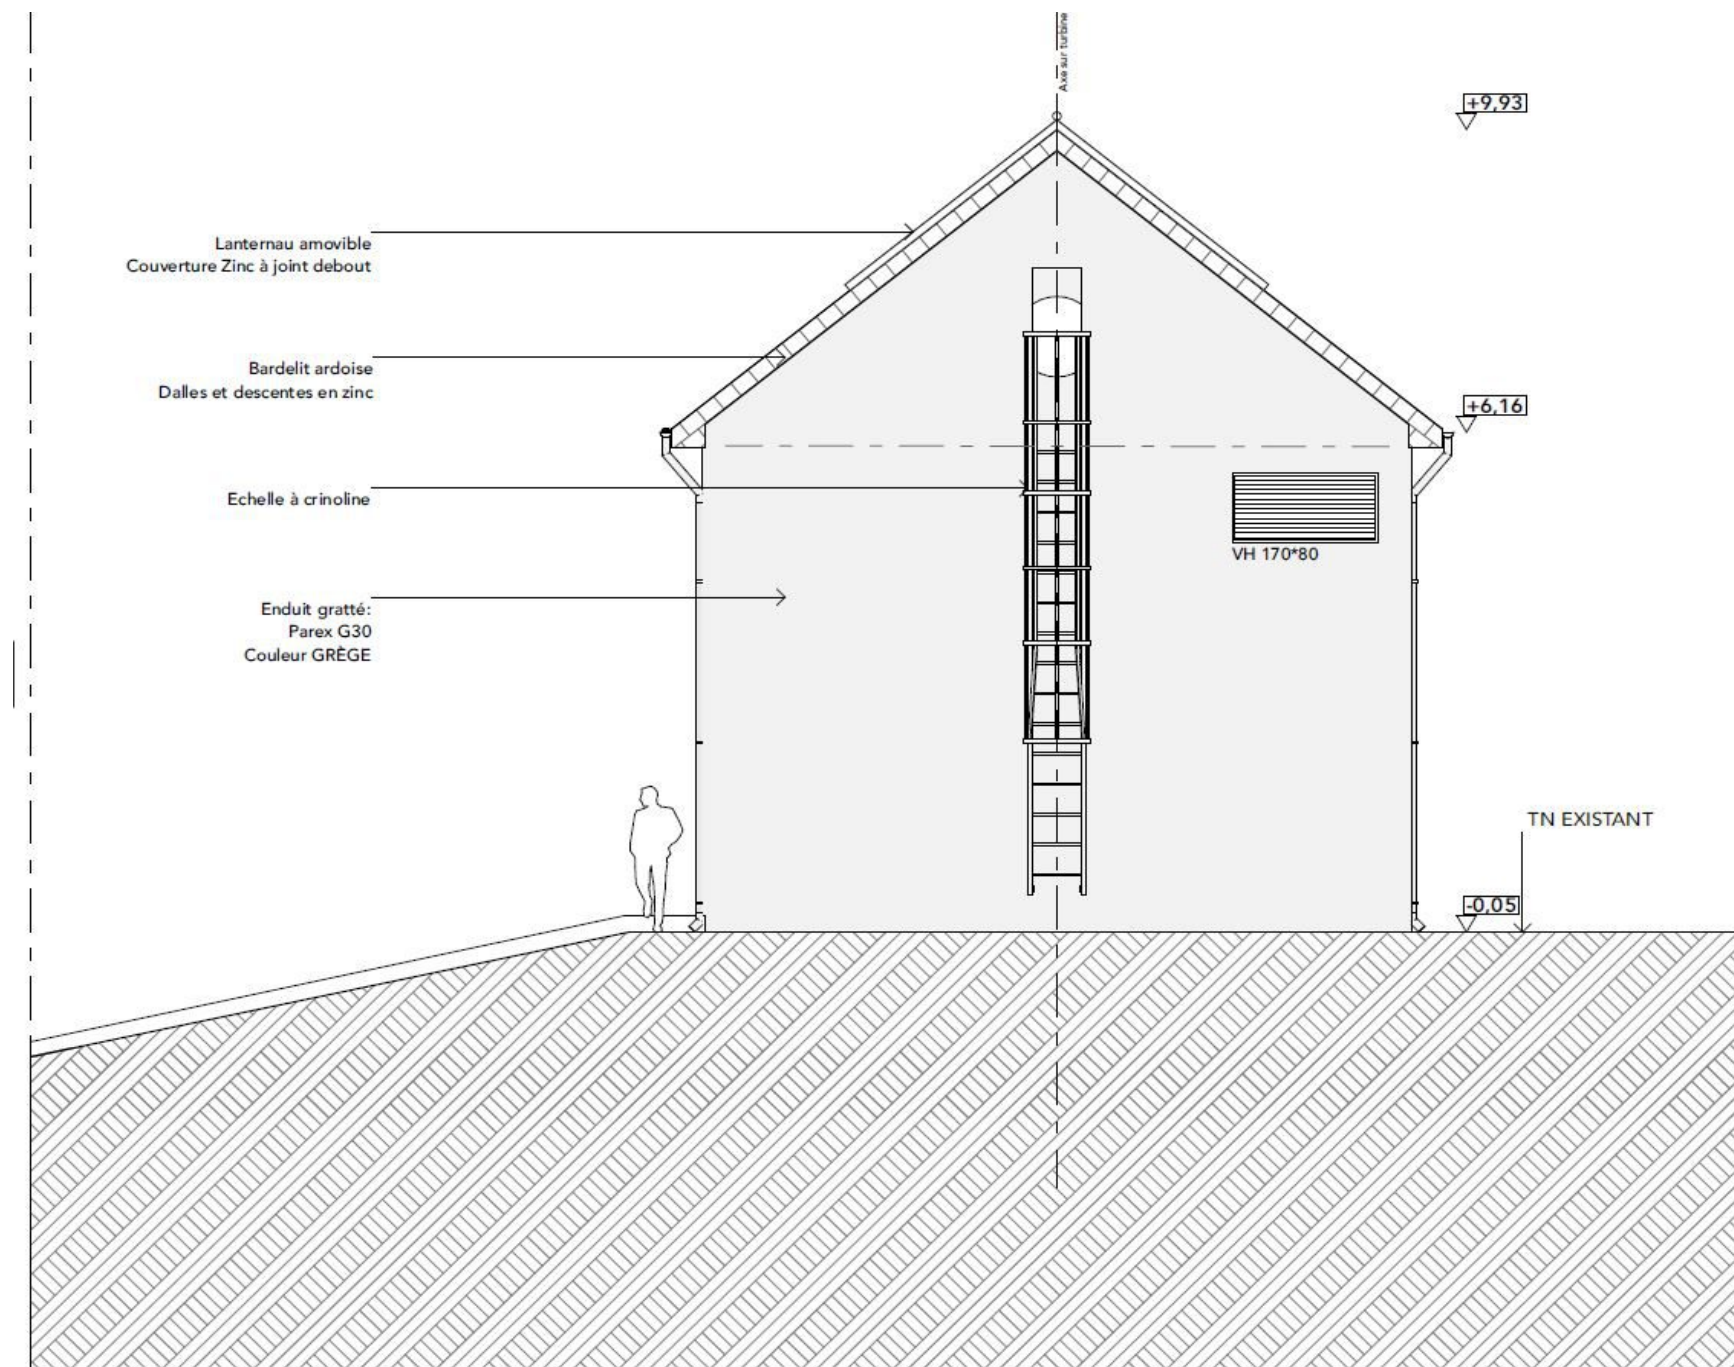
Façade ouest bâtiment centrale (source : PYREN et BB Architectes Associés)
